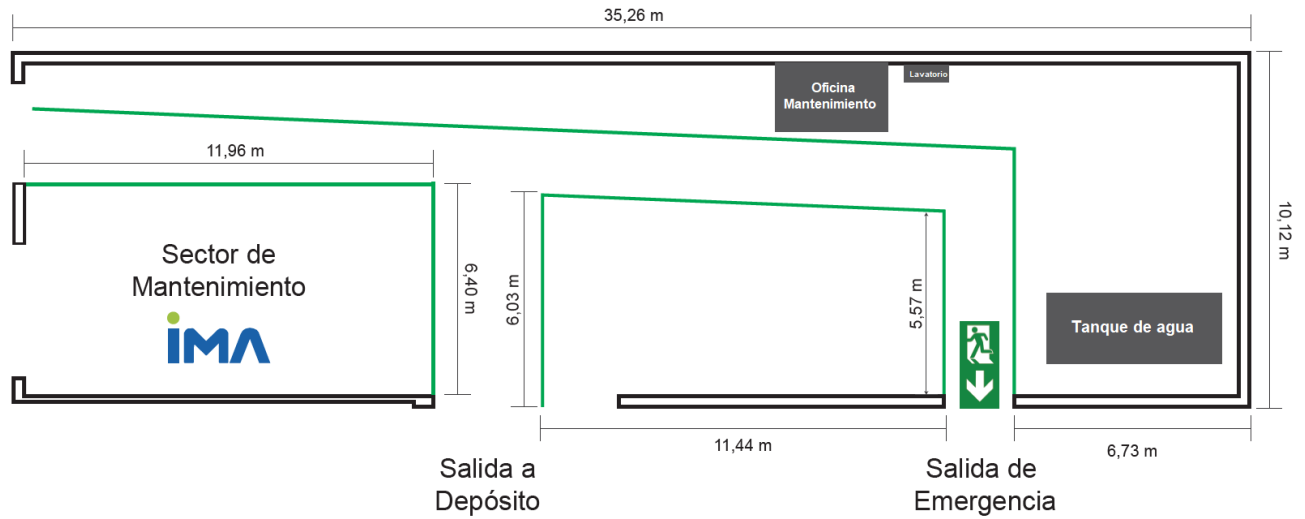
Plano ala norte Tubos Trans Electric. Fuente: elaboración propia
